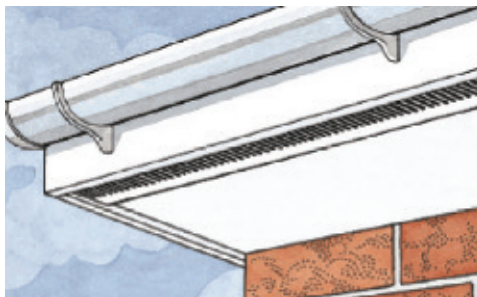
Варианты вентиляции через подшивку карнизного свеса
